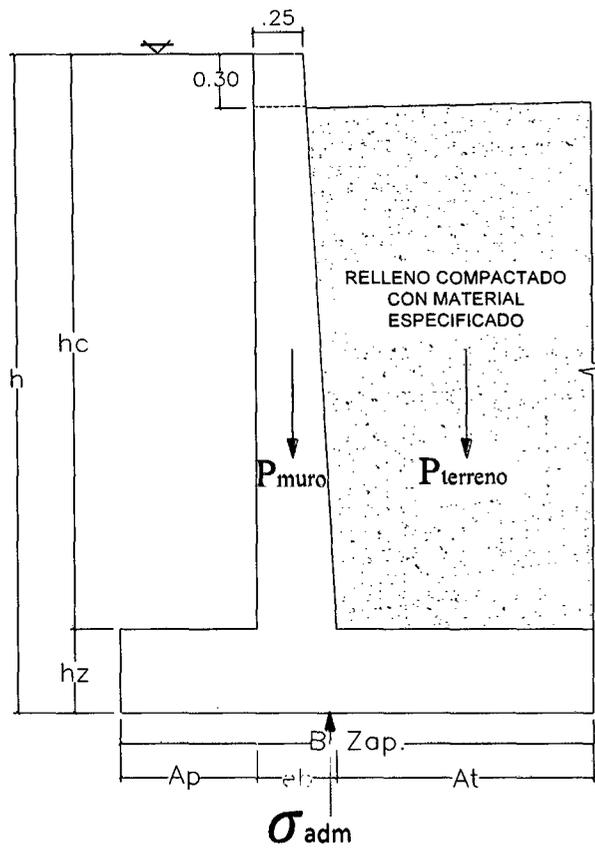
Fuerzas actuantes en el muro de concreto armado.
